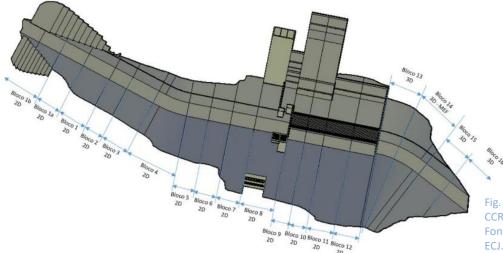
Planta dos blocos de concreto CCR da ECJ.
